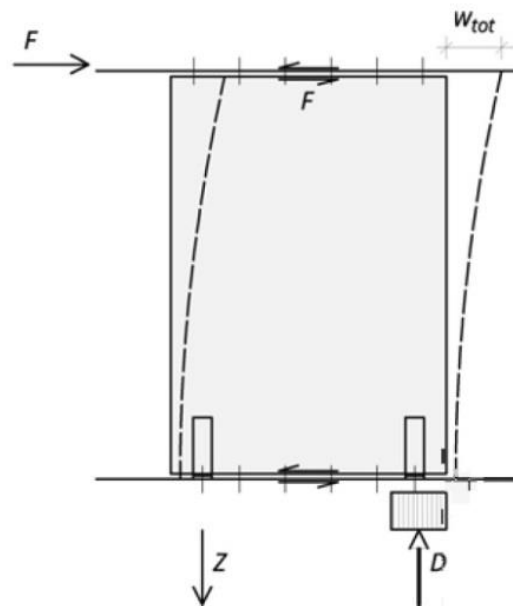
Wandscheibe mit Anbindung zu Decke und Boden [48]
